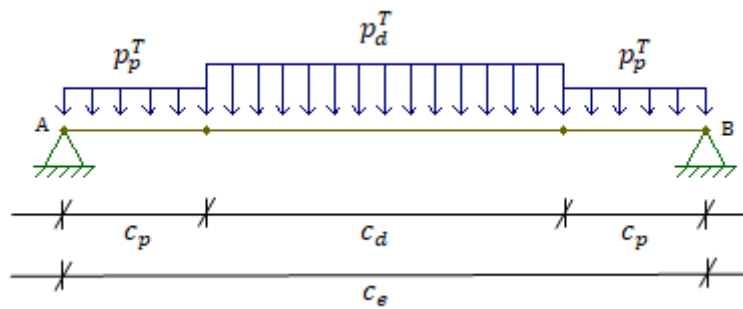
Modelo de carregamento para cálculo da armadura longitudinal de uma escada. (Fonte: autor).
